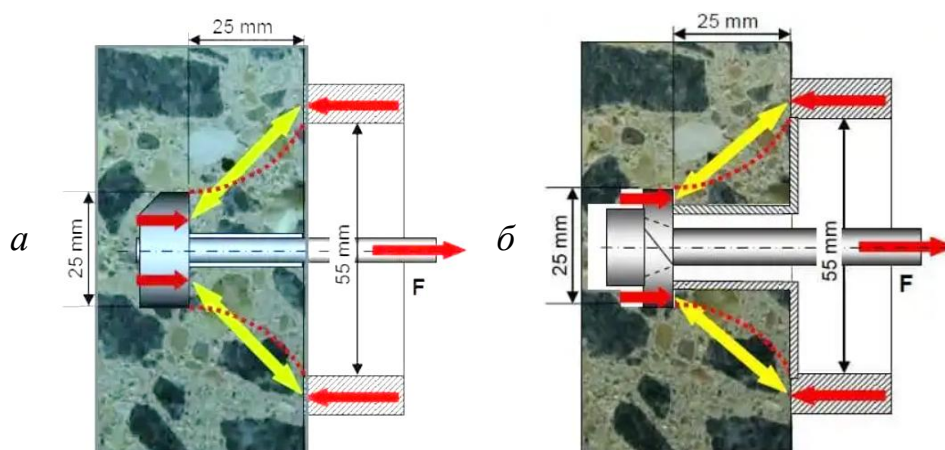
Схема испытаний: (а) LOK-test; (б) CAPO-test (источник: [6])
